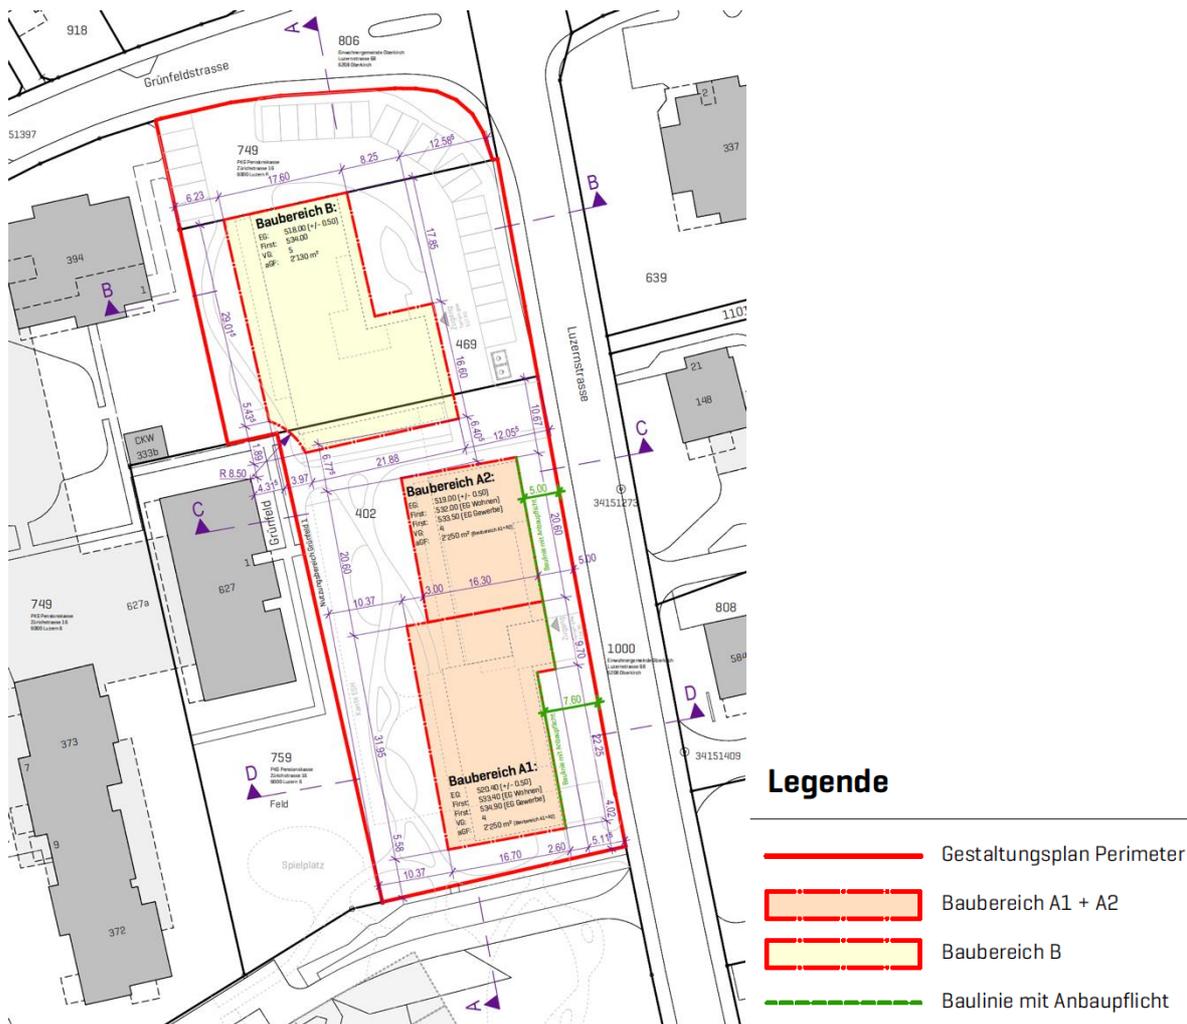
Gestaltungsplan Feld: Baubereiche
